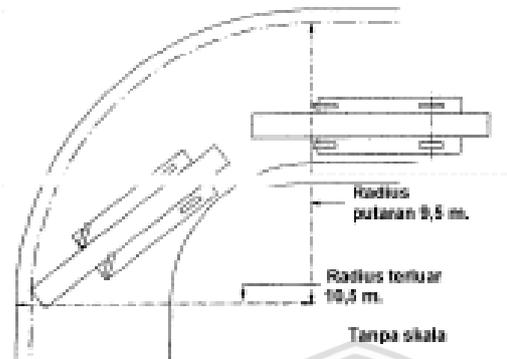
Pencapaian tangga kendaraan pemadam ke bangunan
